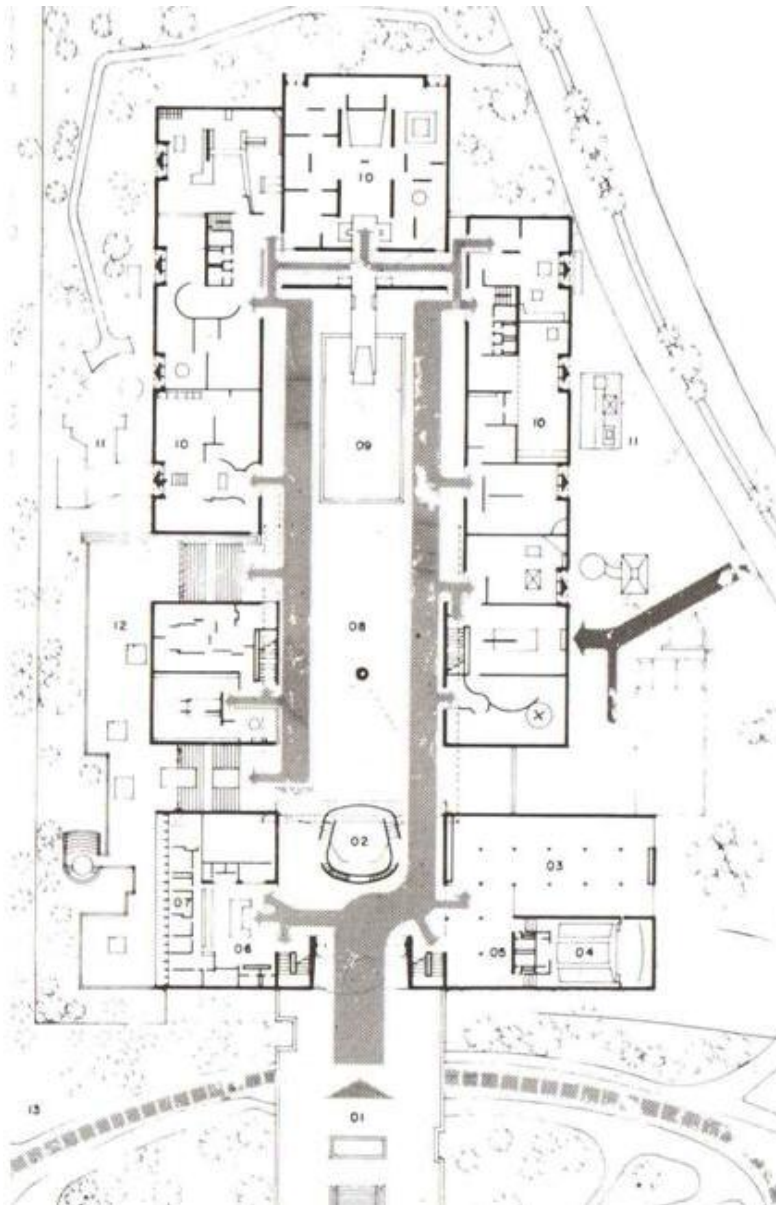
Planta arquitectónica del Museo Nacional de Antropología.
